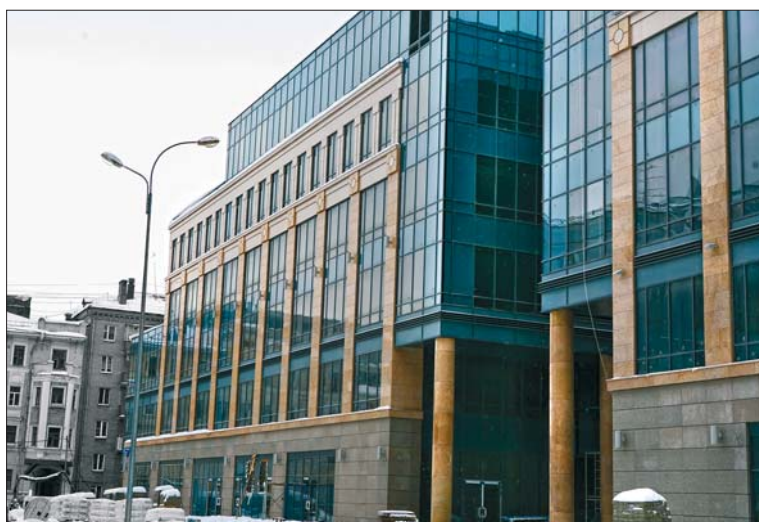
«Ронсон-400» с облицовкой натуральным гранитом (600 x 900 x 30): элементы декора из натурального гранита имеют перепады по плоскости до 350 мм, колонны выполнены из гранитных оболочек толщиной 50 мм на внутренней несущей стальной колонне
